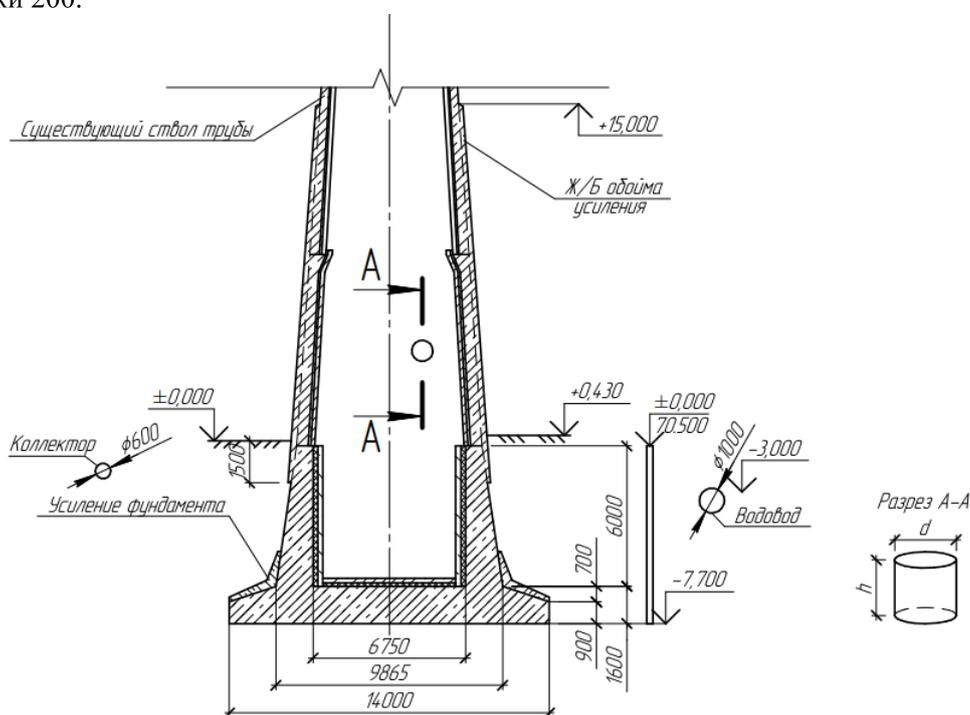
Поперечный разрез дымовой трубы коксовых батарей №5 и №6
